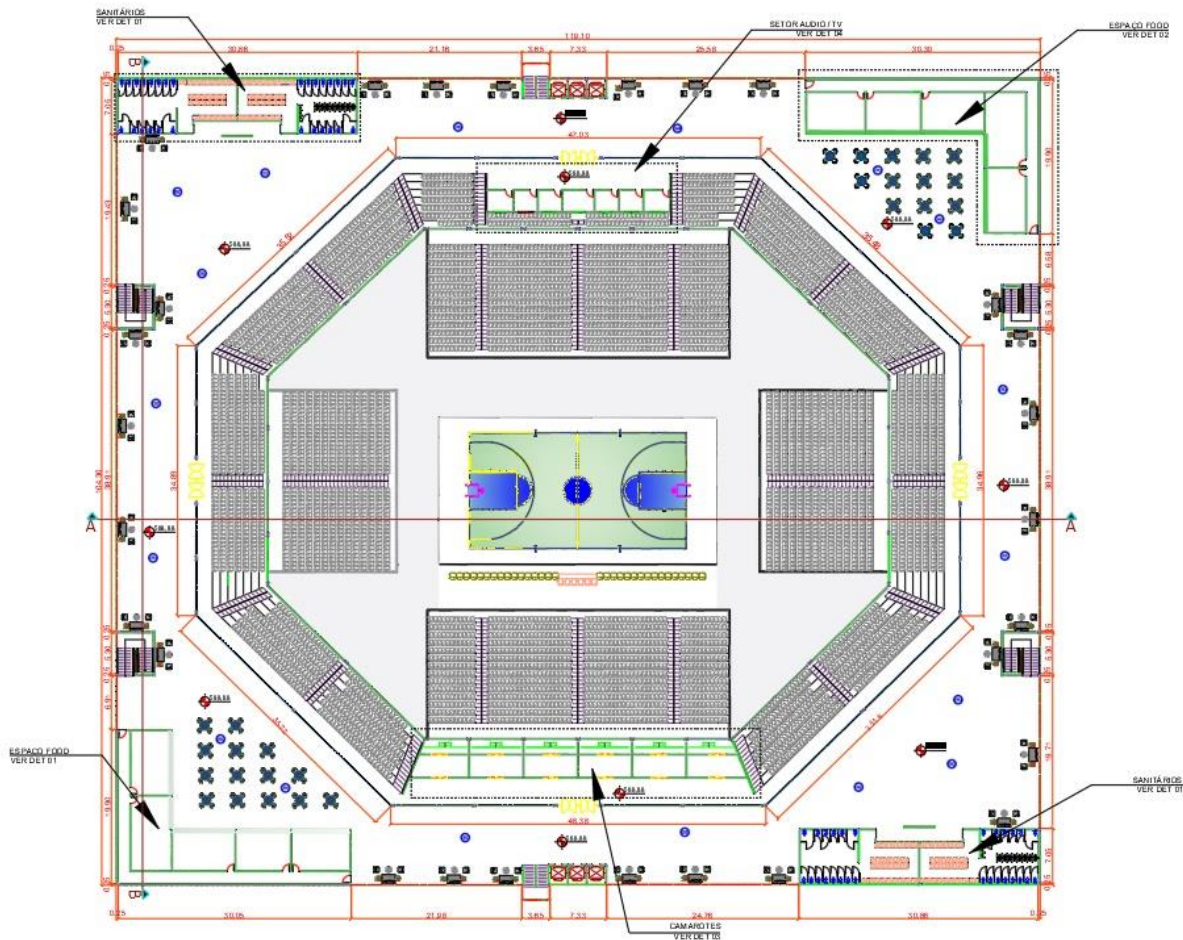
Pavimento Térreo – (Fonte Acervo do Autor)
